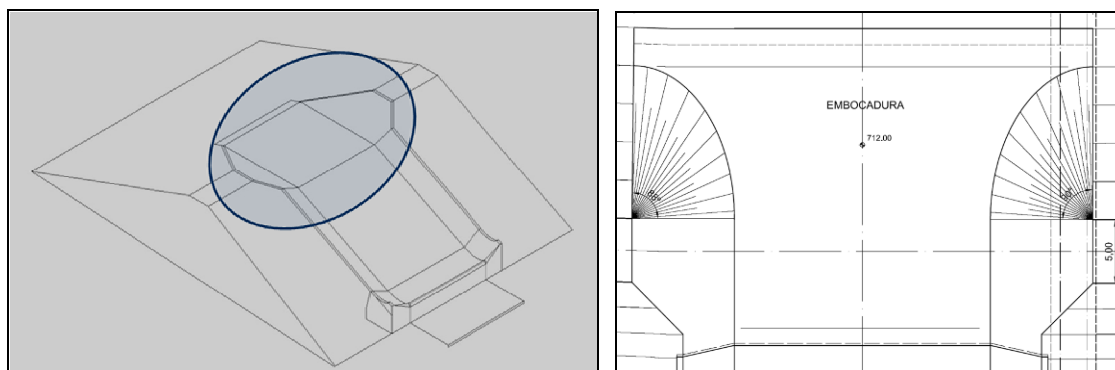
Embocadura del aliviadero. Croquis 3D y vista en planta
